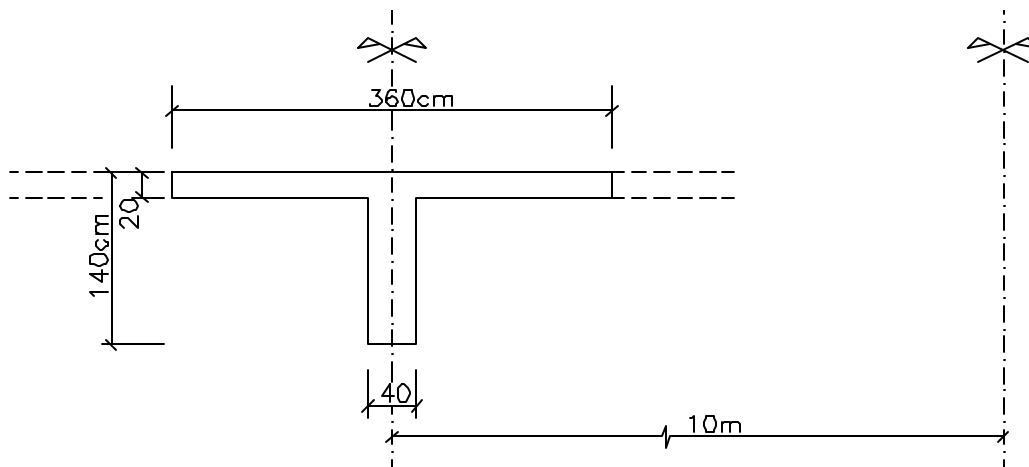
Exemplo 1 - Esquema da seção transversal da viga
